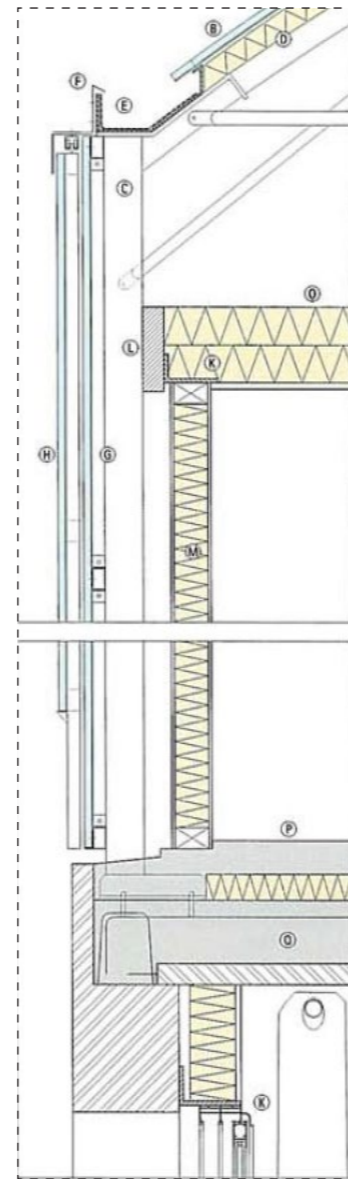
Detalle constructivo 1. Sección de envolvente opaca. Espacio aislado y calefactado.
